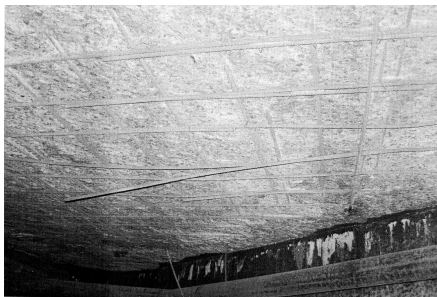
Общий вид железобетонного перекрытия, подверженного воздействию пожара
